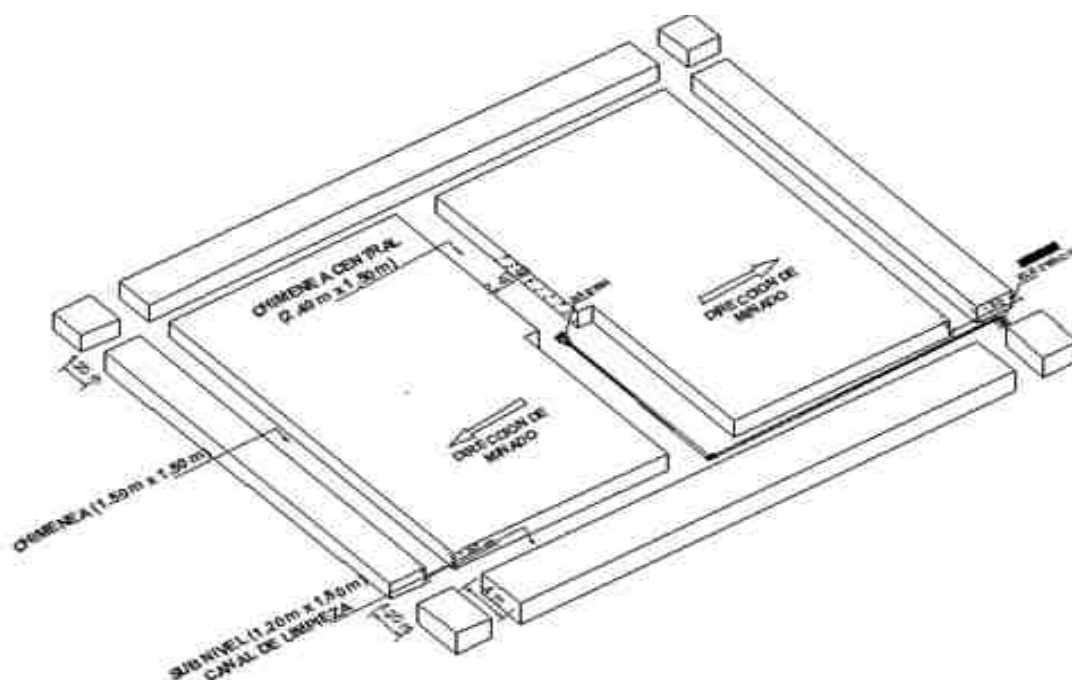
Preparación de chimenea central de sección de 2.40m x 1.50m
